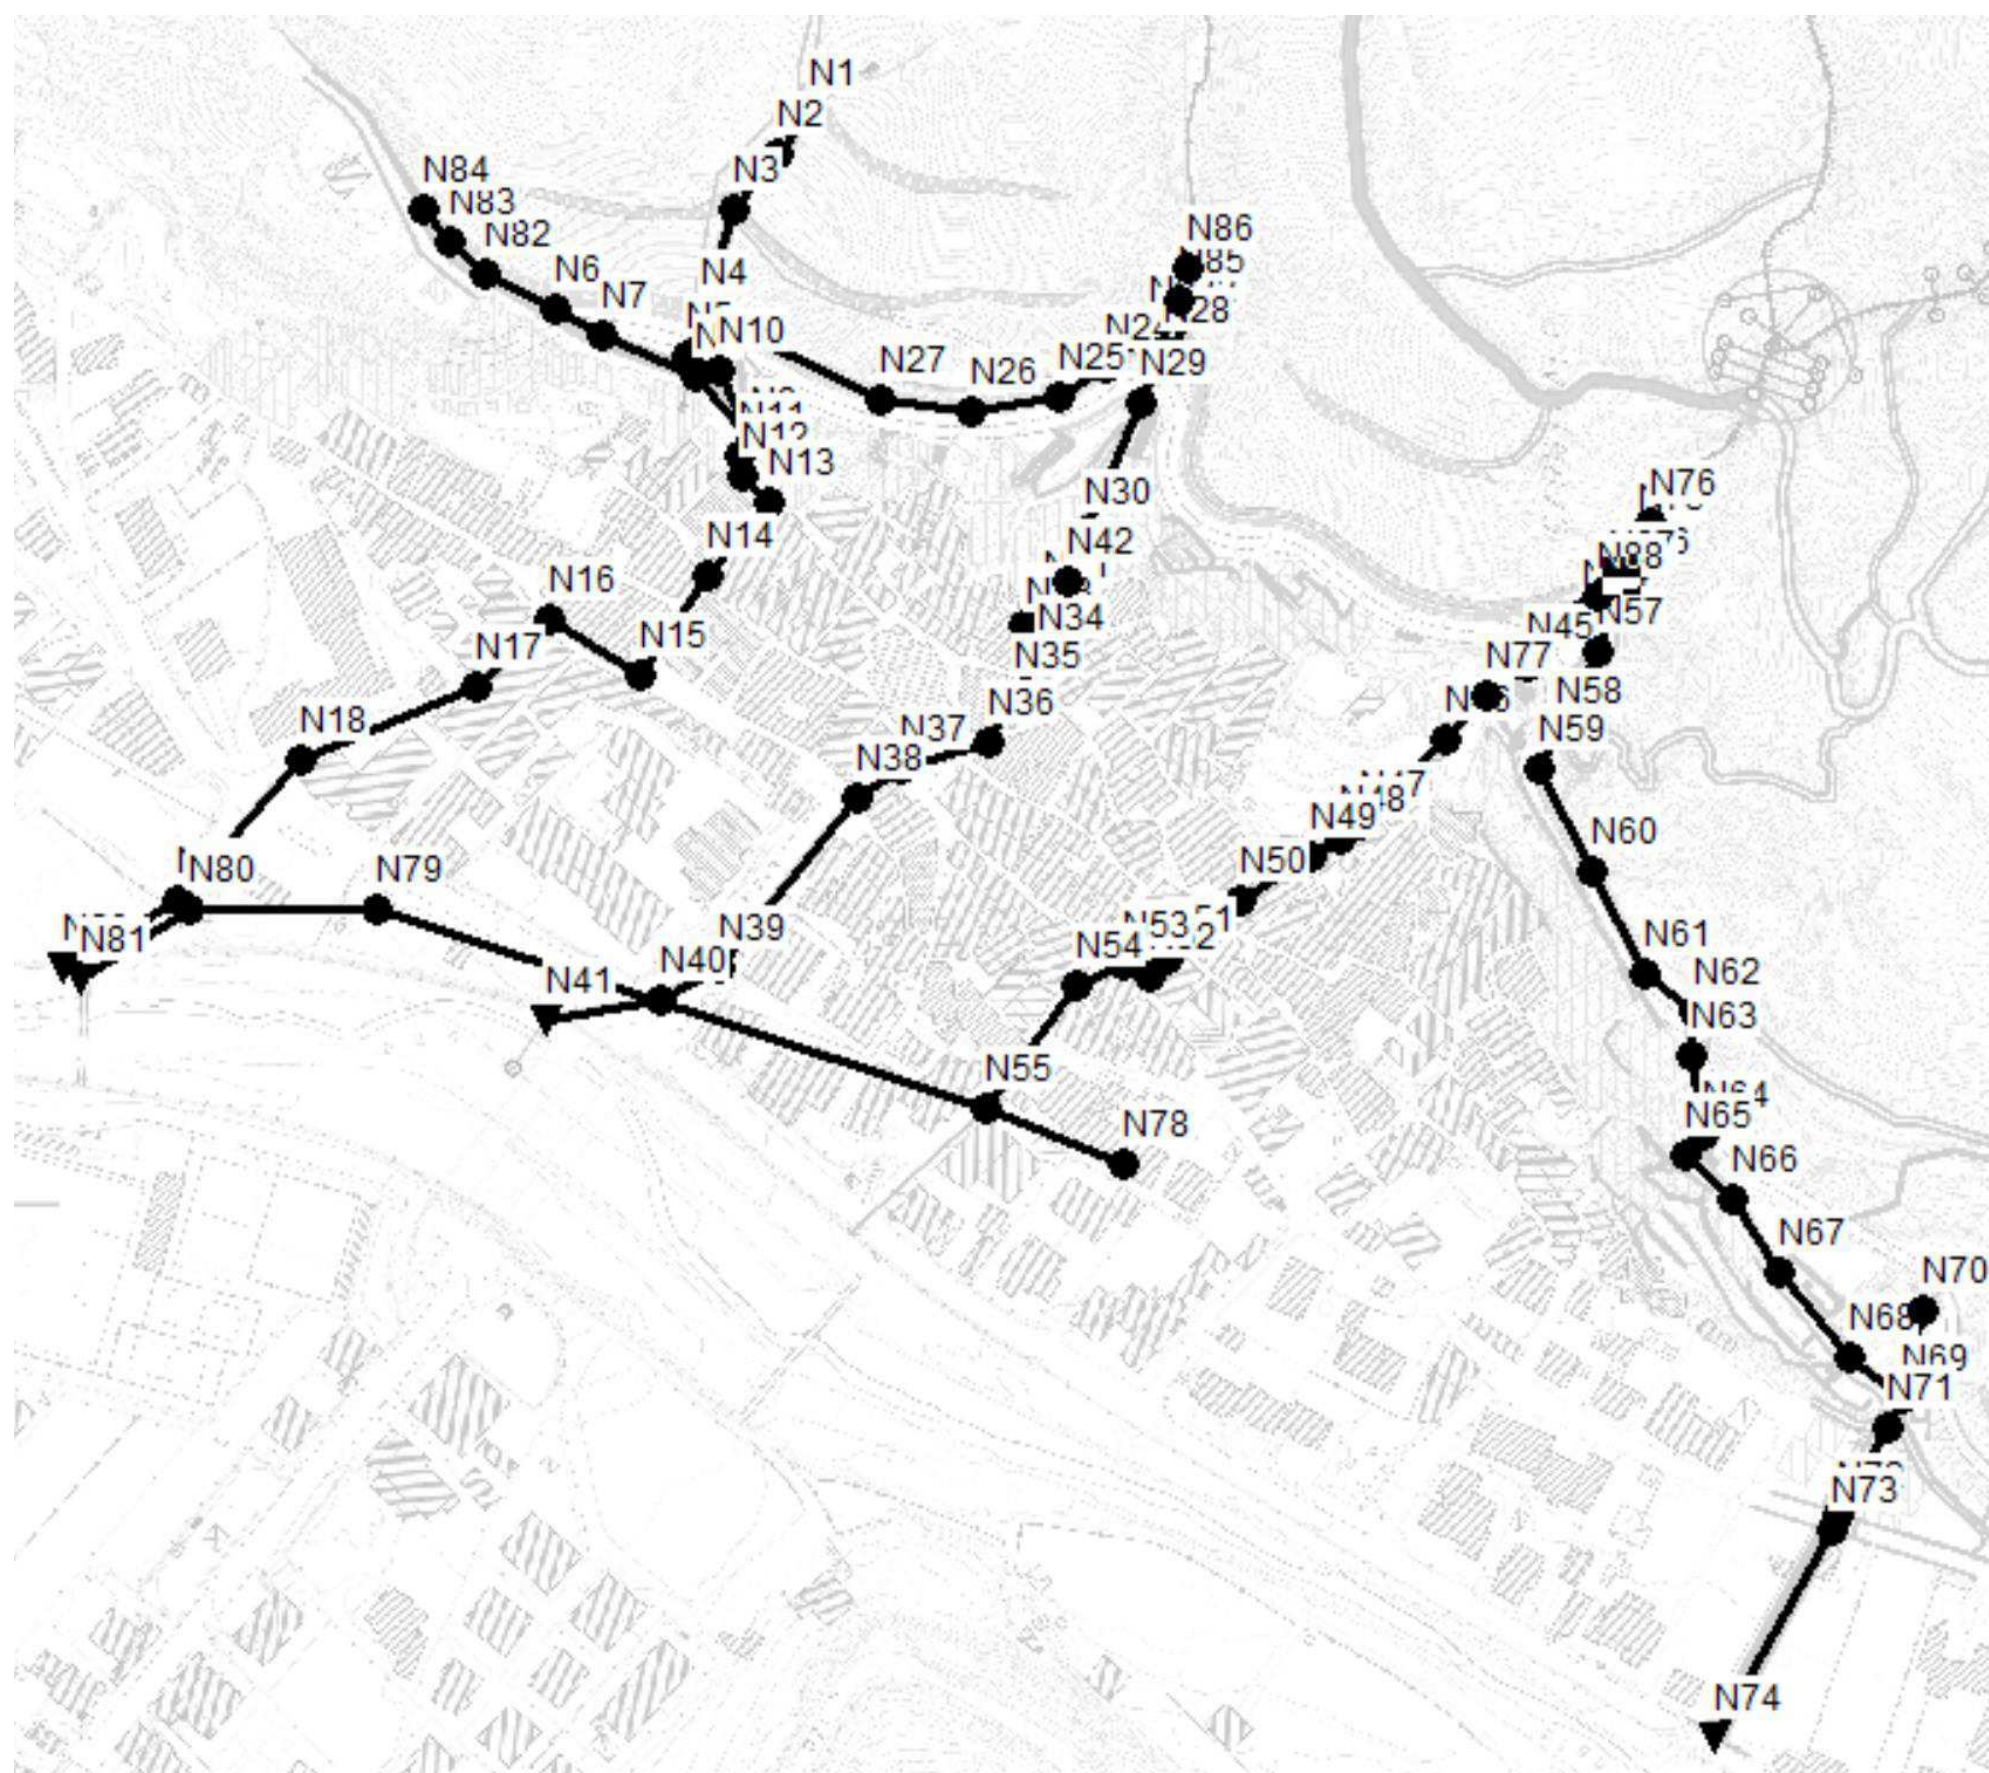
schema planimetrico stato di progetto della rete di collettori che drenano i fossi della collina.
